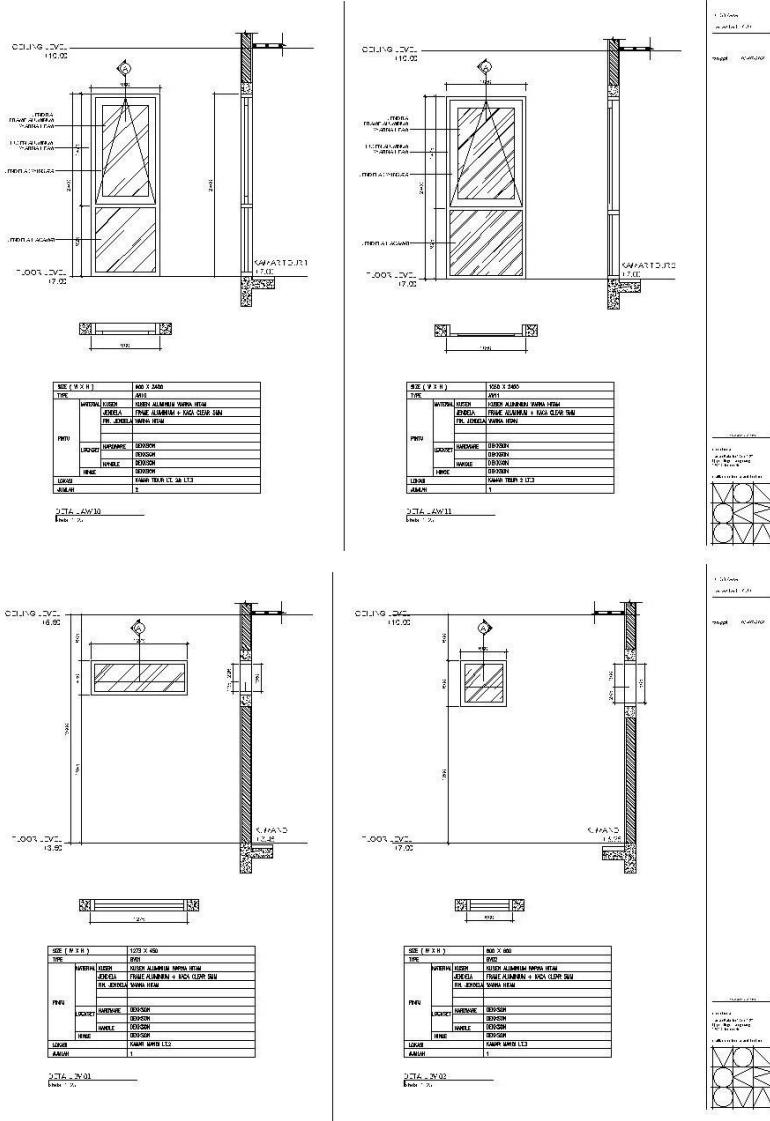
32 Detail Jendela 1 Reswara tipe Ranjana E3
